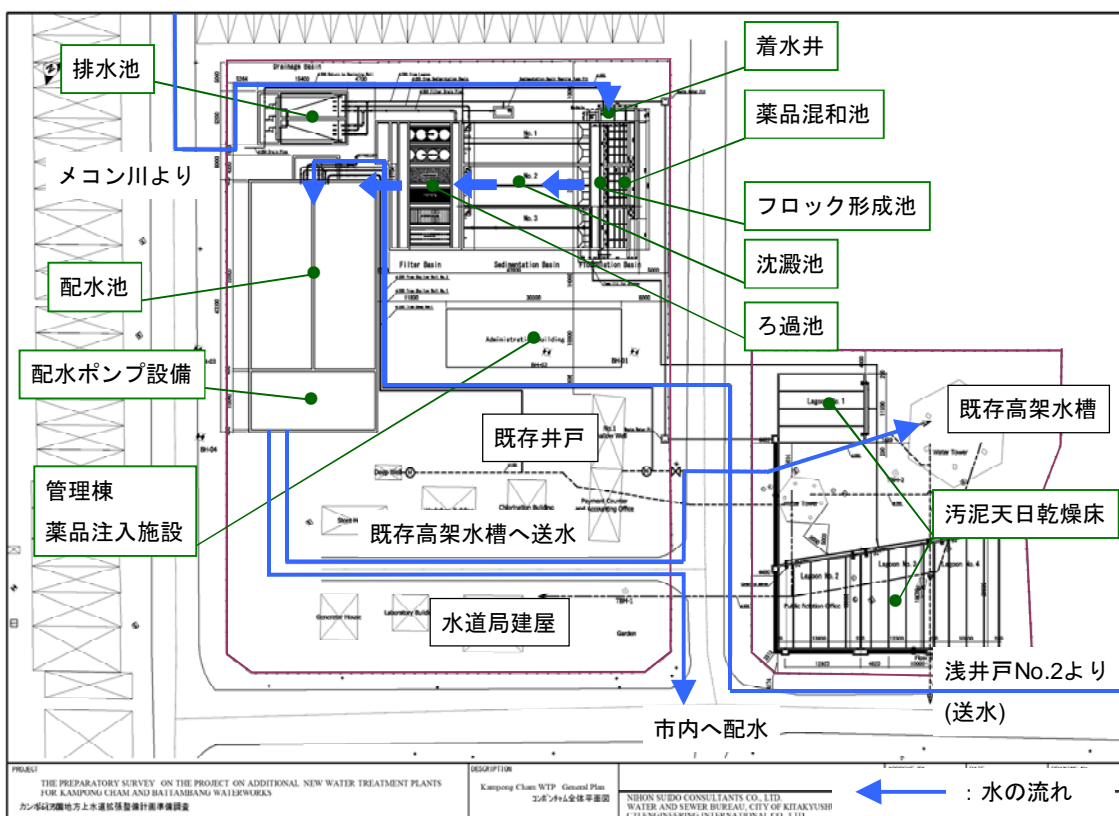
コンポンチャム浄水施設配置図
